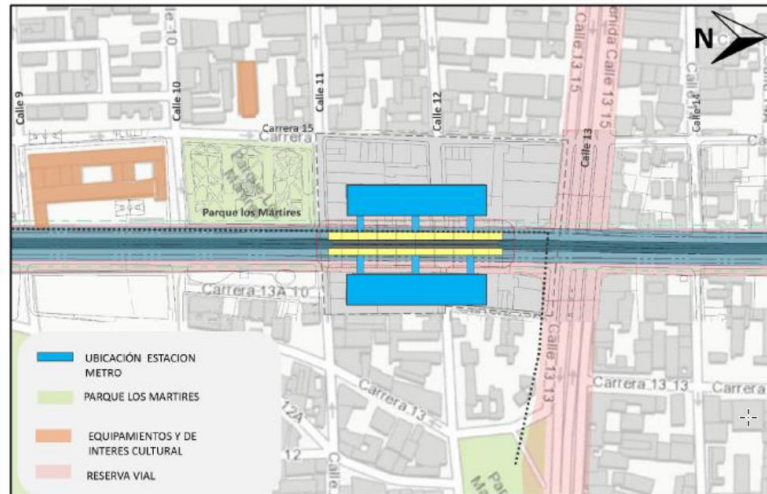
Afectación ubicación Estación de Metro proyectada.
